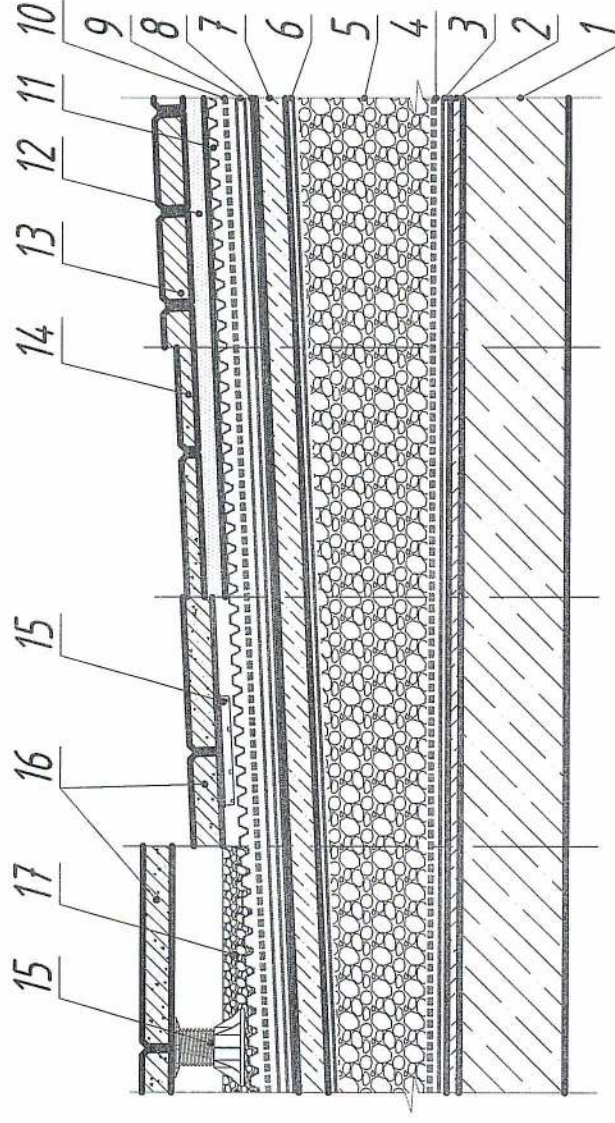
Принципиальная схема конструктивного исполнения настла бесчердачного покрытия выполняемого по железобетонному основанию (эксплуатируемая кровля под пешеходную нагрузку)
